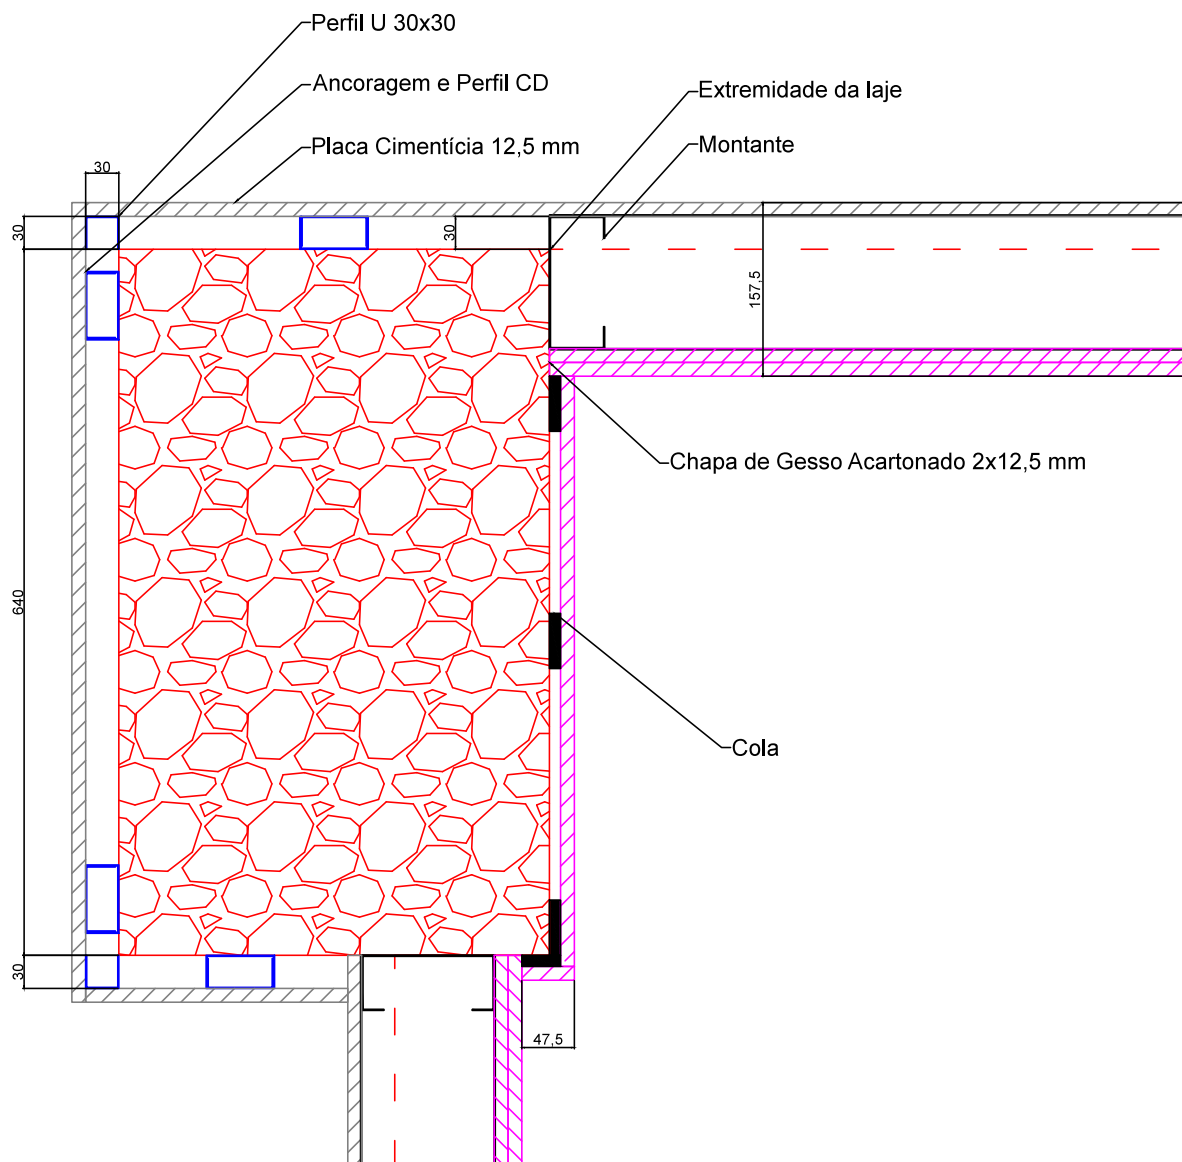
Pilar P4 e solução de Fachada Leve. Vista em Planta. Dimensões em milímetros.
